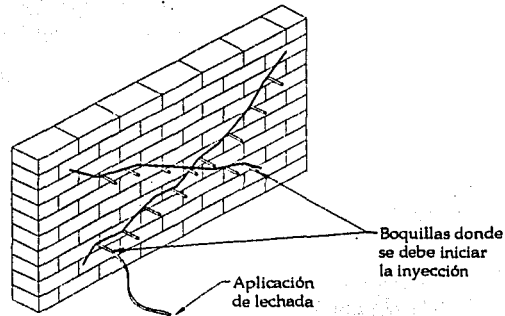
Inyección de lachada de cemento en grietas en un muro de prueba en un laboratorio (Tomazevic y Anicic, 1989)
